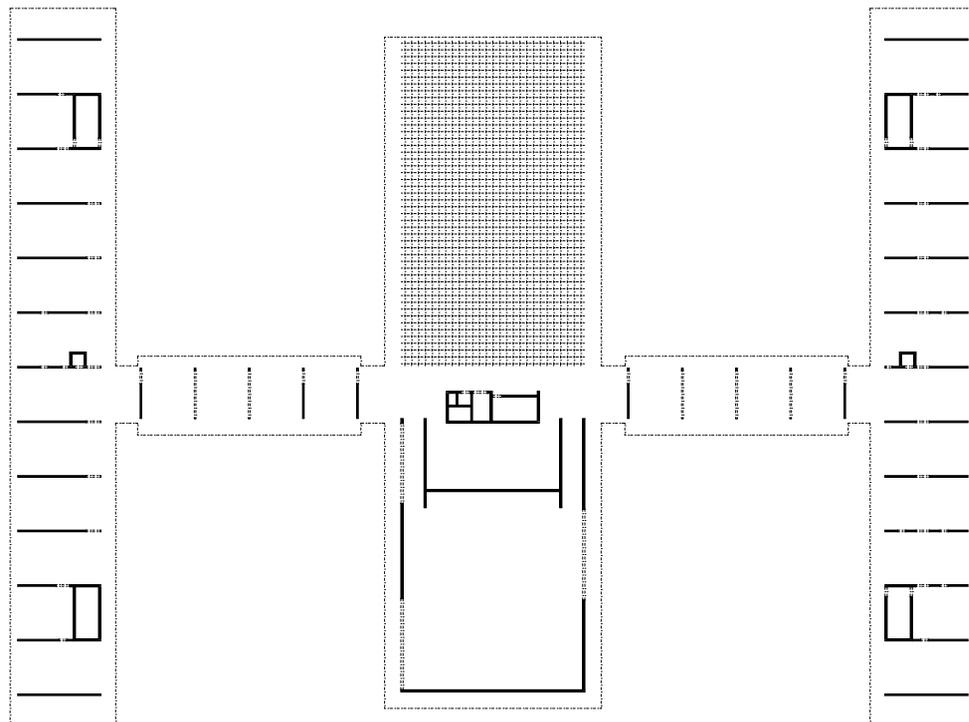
Tragstruktur Kloster Baldegg, Erdgeschoss
